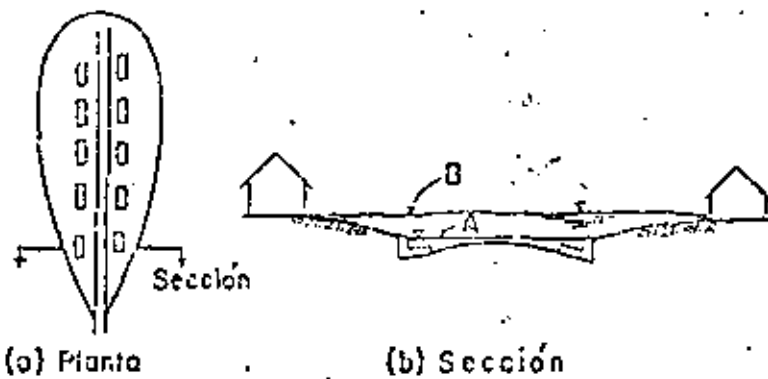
DESAGUE URBANO SIMPLE, PLANTA Y CORTE TRANSVERSAL.
